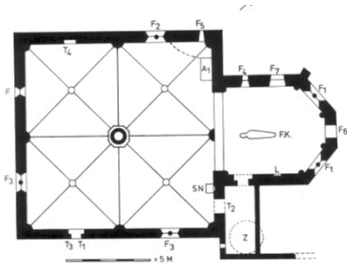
Kerpen, St. Stephan und Sebastian, Grundriss
